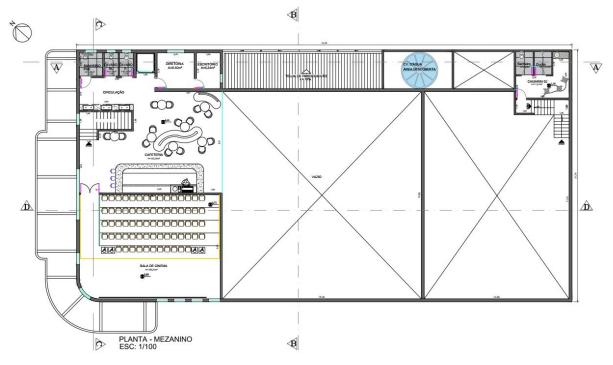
Planta de reforma do mezanino. (Fonte: produção do autor)
